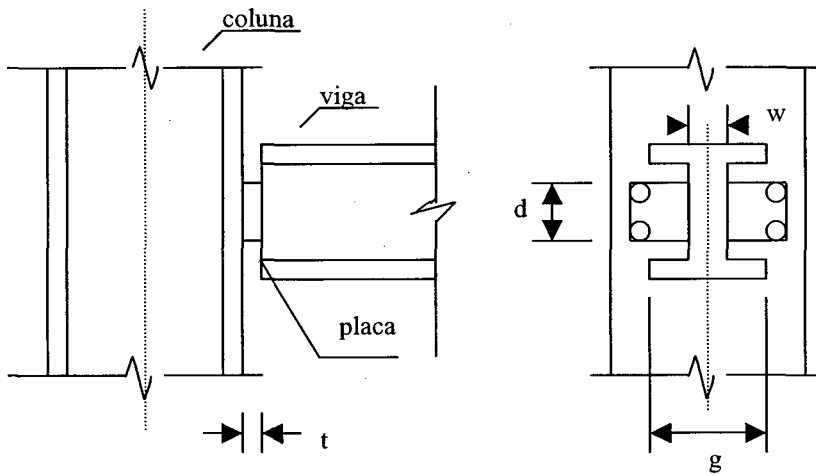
Típica conexão viga-pilar metálica “header plate”.
